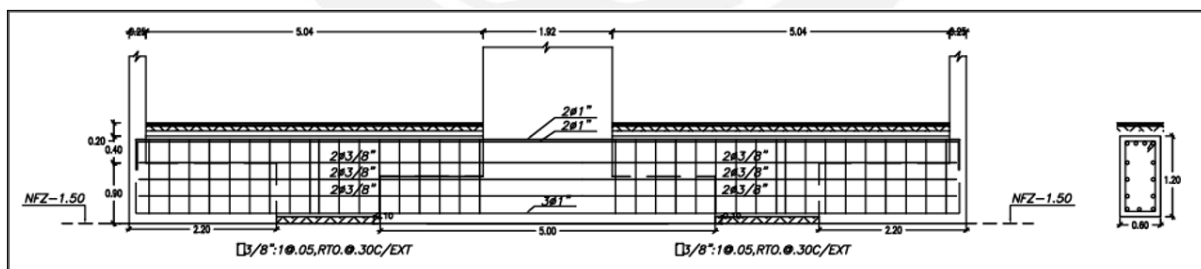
Esquema final en elevación de la zapata conectada VC-02.
